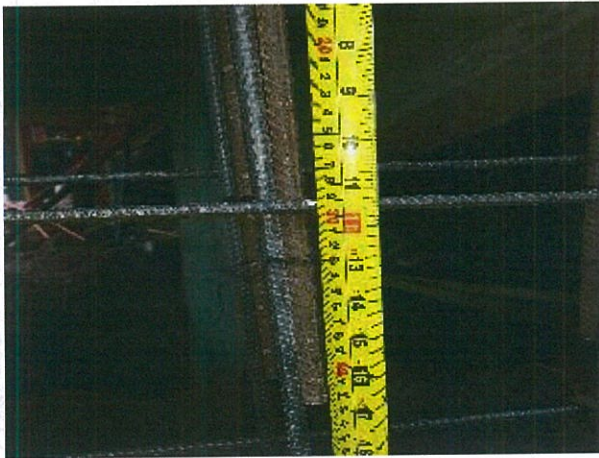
, 23-06-2015, detalle de la deformación en el pilar P02 del eje 30 con el eje A.
